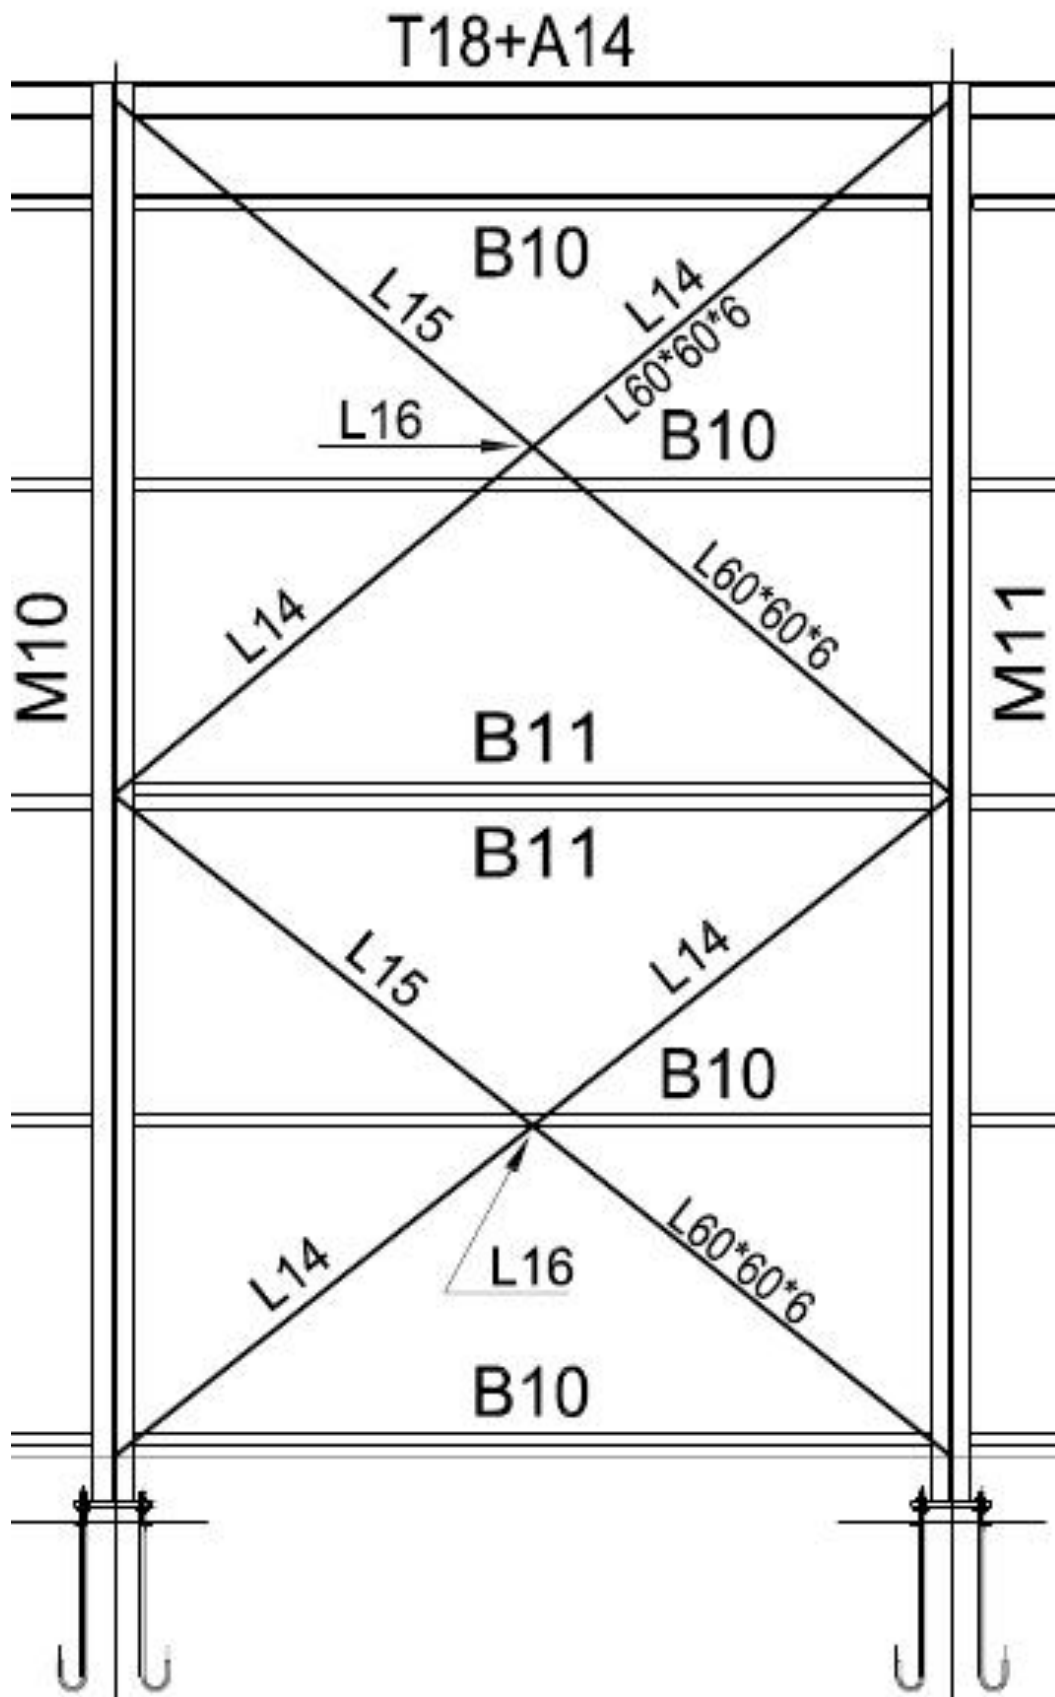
Particolare di A.2001.a.sa.T02 - Piante e prospetto - Schema tipo controventi di facciata
